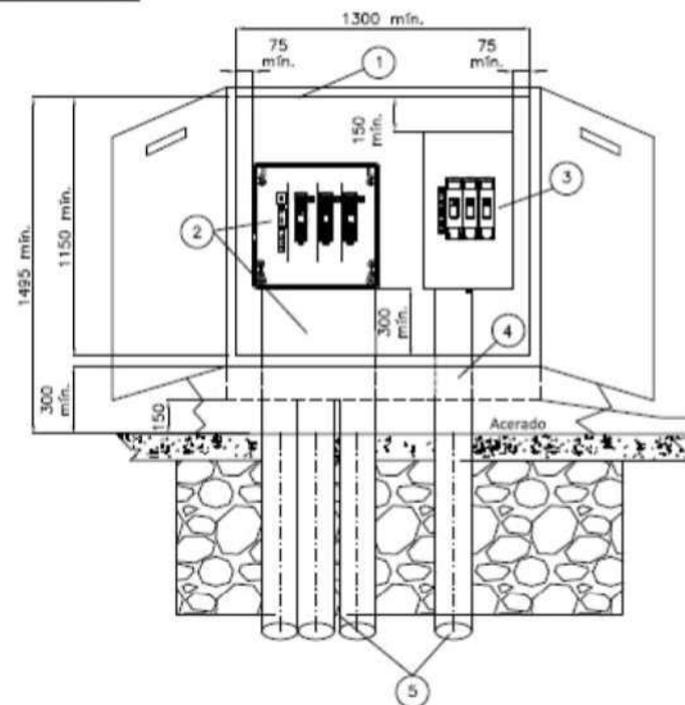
Instalación CPG y CS montaje vertical. Alzado.
